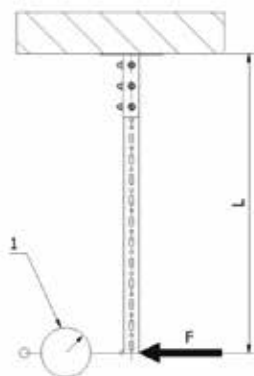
Configurazione di prova per staffa fissata a muro / *Test set-up for a wall fixed cantilever bracket
